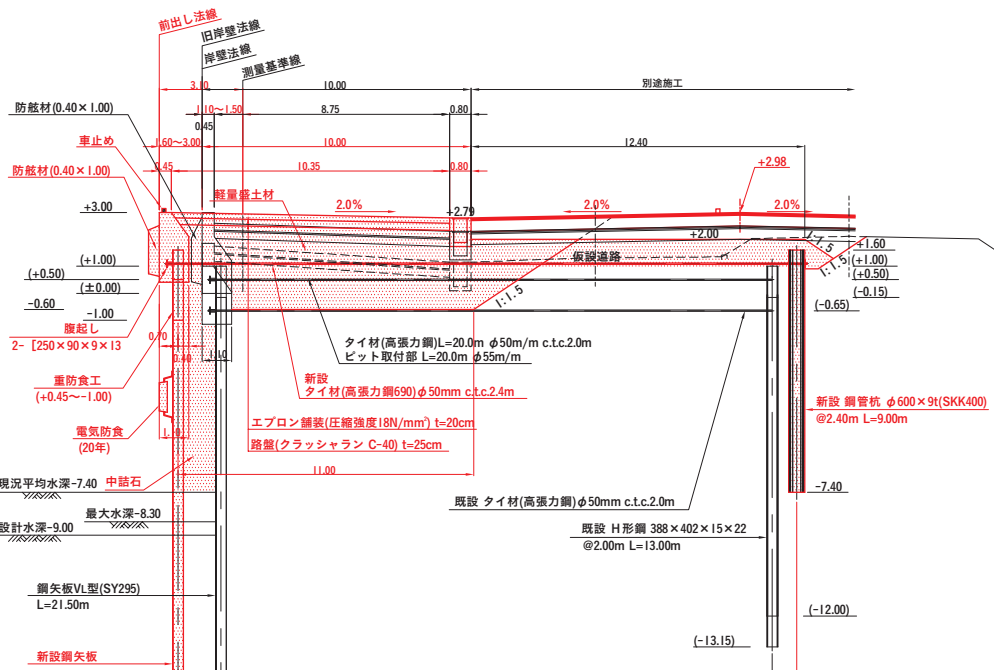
設計水深－7m岸壁 復旧標準断面図
